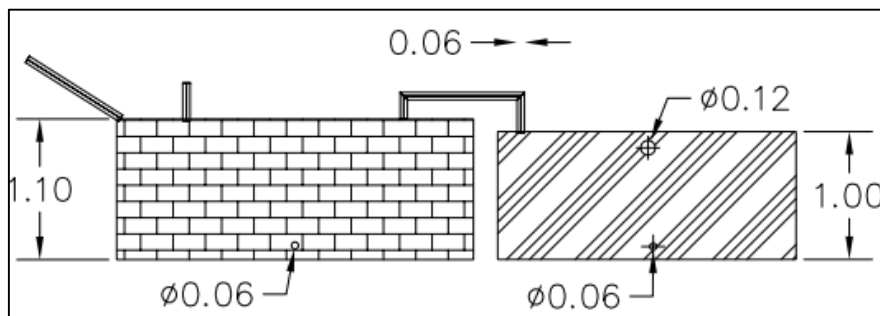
Plano Estructural Tanques de Captación Vista Lateral
